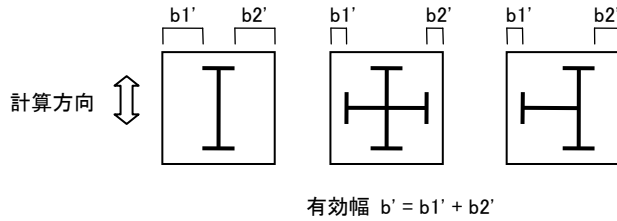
SRC柱の有効幅 b' のとり方
